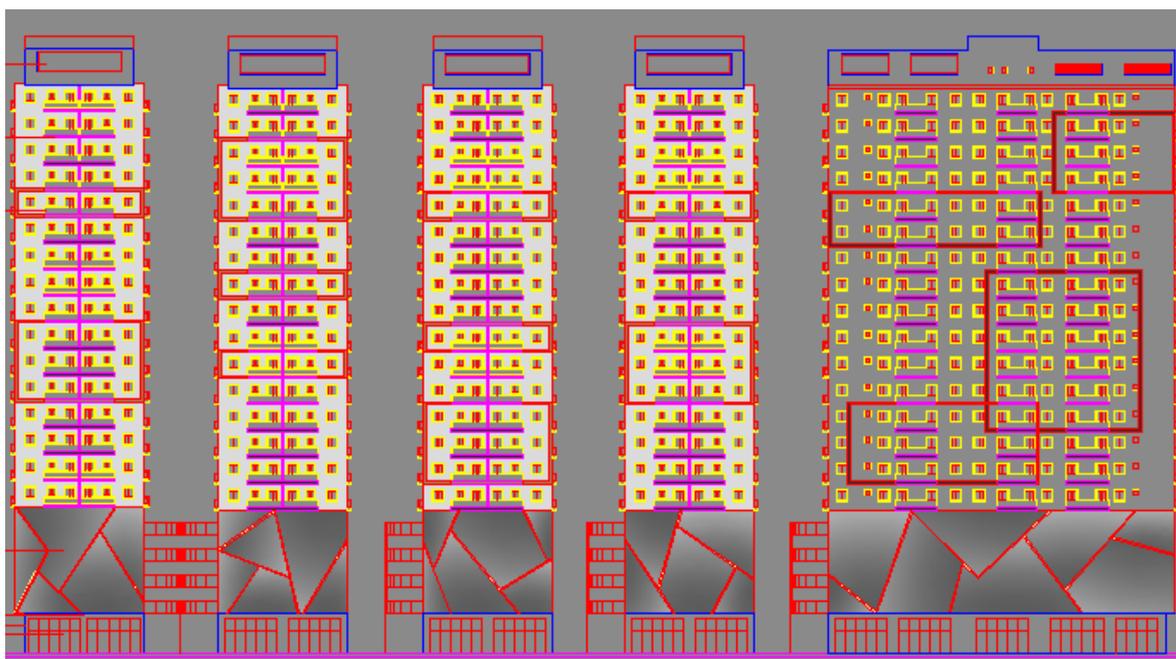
Croqui de elevação - Rua Marquês de Herval
